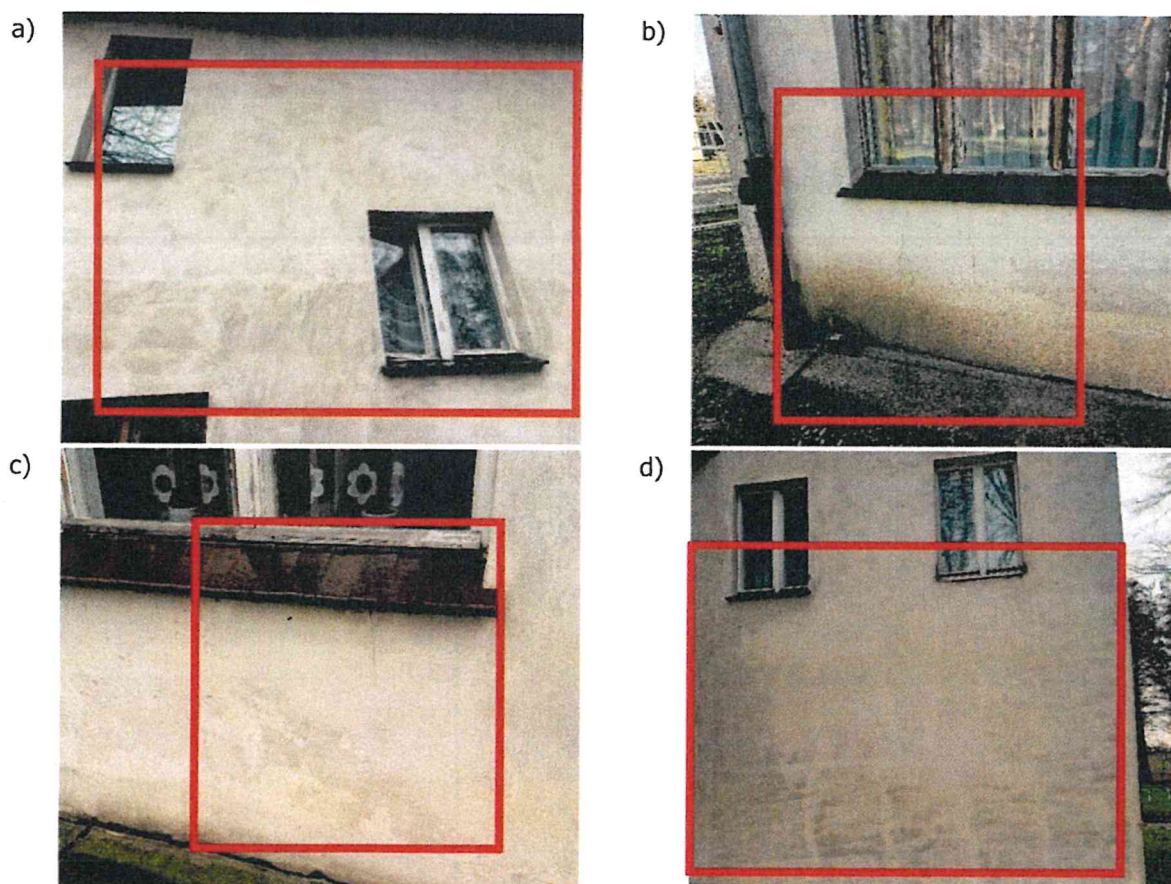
Widok elewacji od strony szczytowej oraz z boku.
